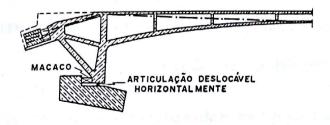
PÓRTICO COM PILAR CURTO E RÍGIDO
